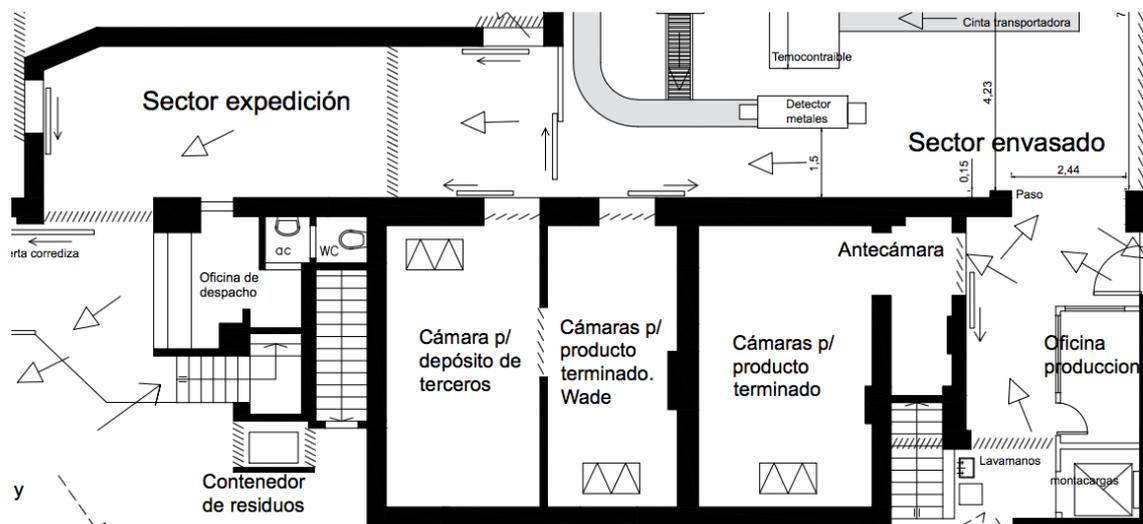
LAYOUT propuesto. Véase la cámara para producto terminado de Wade.
